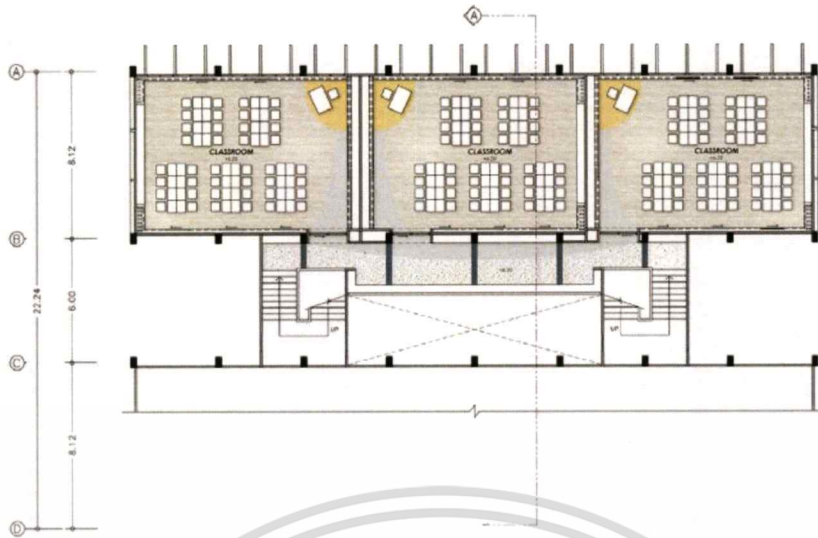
ภาพแสดงผังเฟอร์นิเจอร์ของ Building A ชั้น 1
